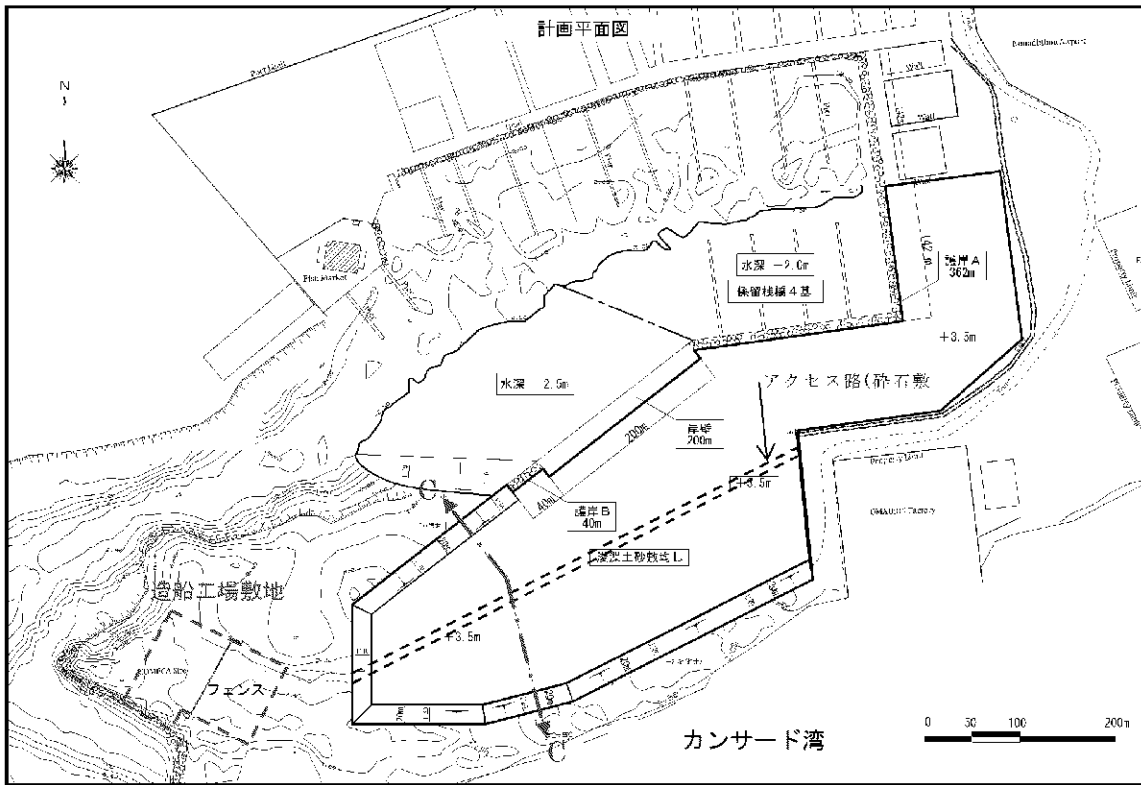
(11) 浚渫土砂の敷き均し計画平面図
